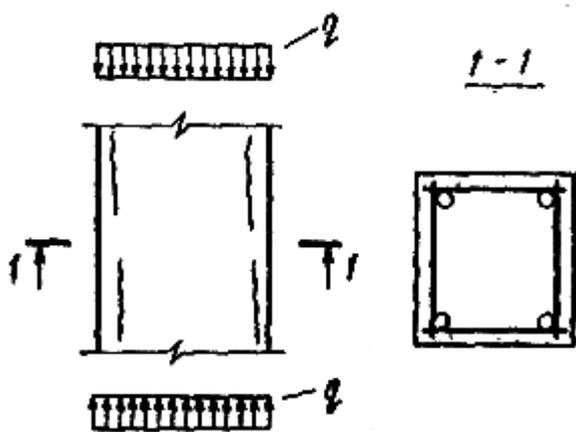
Трещины вдоль продольной арматуры в сжатых элементах
